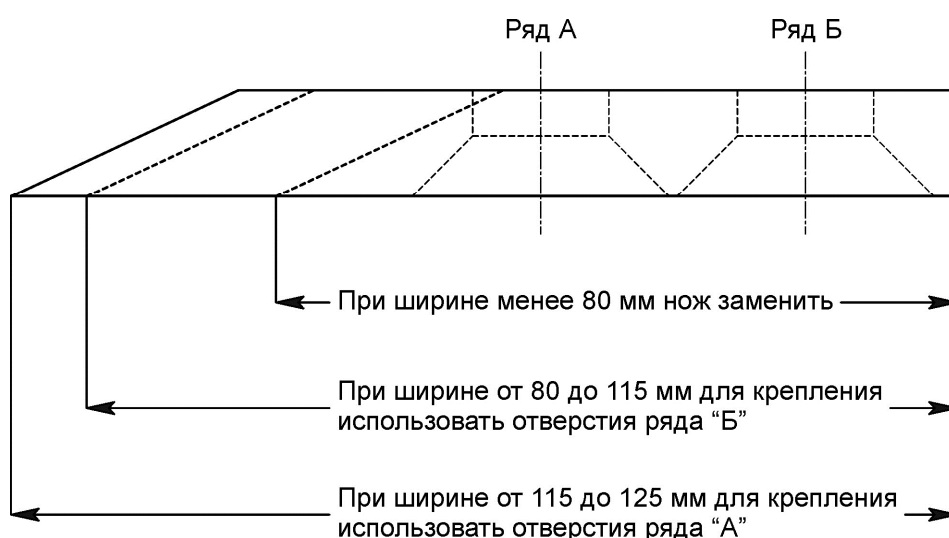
Выбор ряда отверстий для крепления ледового ножа
